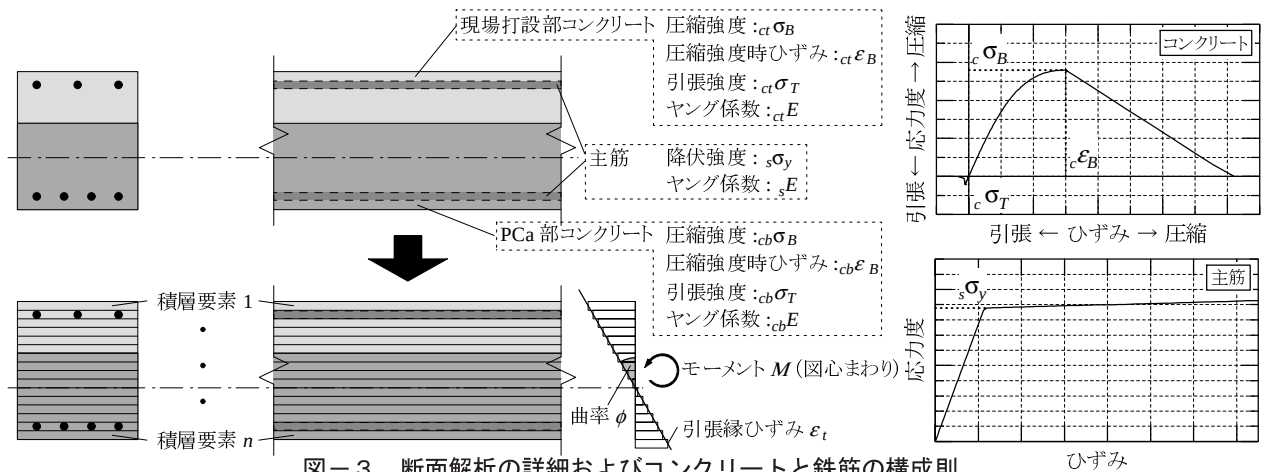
断面解析の詳細およびコンクリートと鉄筋の構成則
